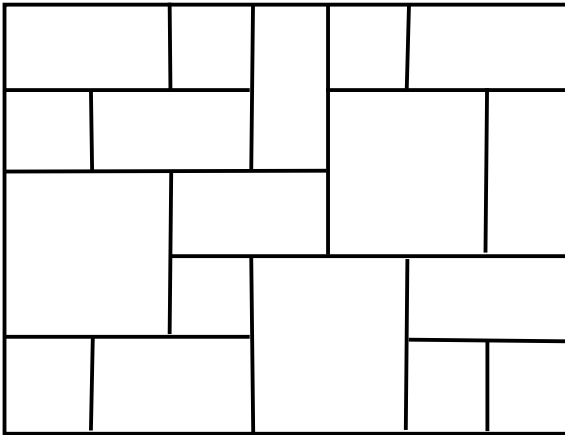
Propuesta de módulo 140x70cm, colocación de piedra laja en Patio Central. Fuente: Plano de propuesta Pro-03.
